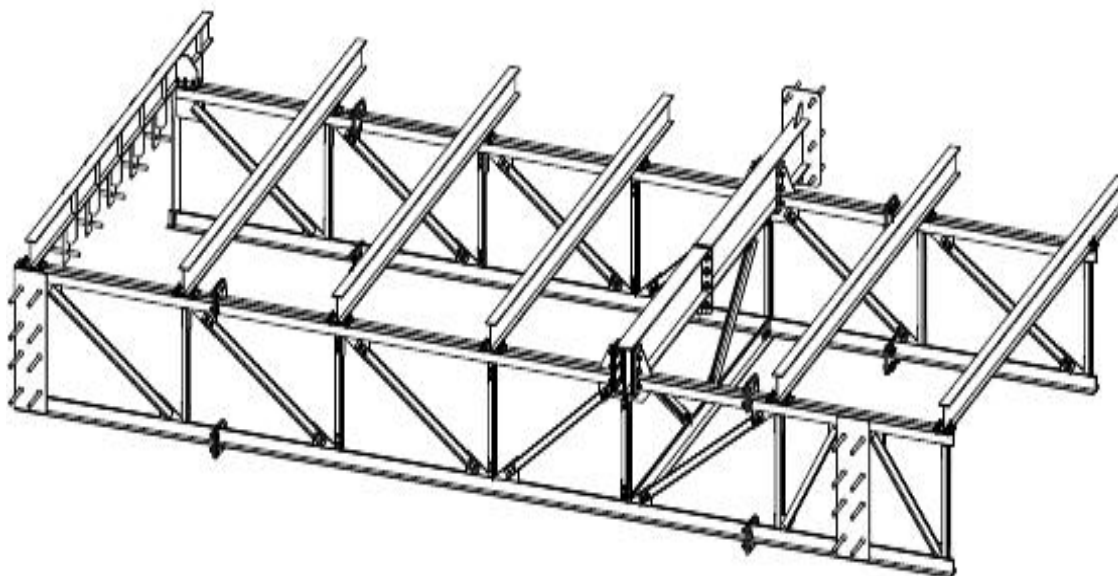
Particolare di A.2010.a.sa.T01 - Progetto della struttura metallica - Vista assonometrica struttura
